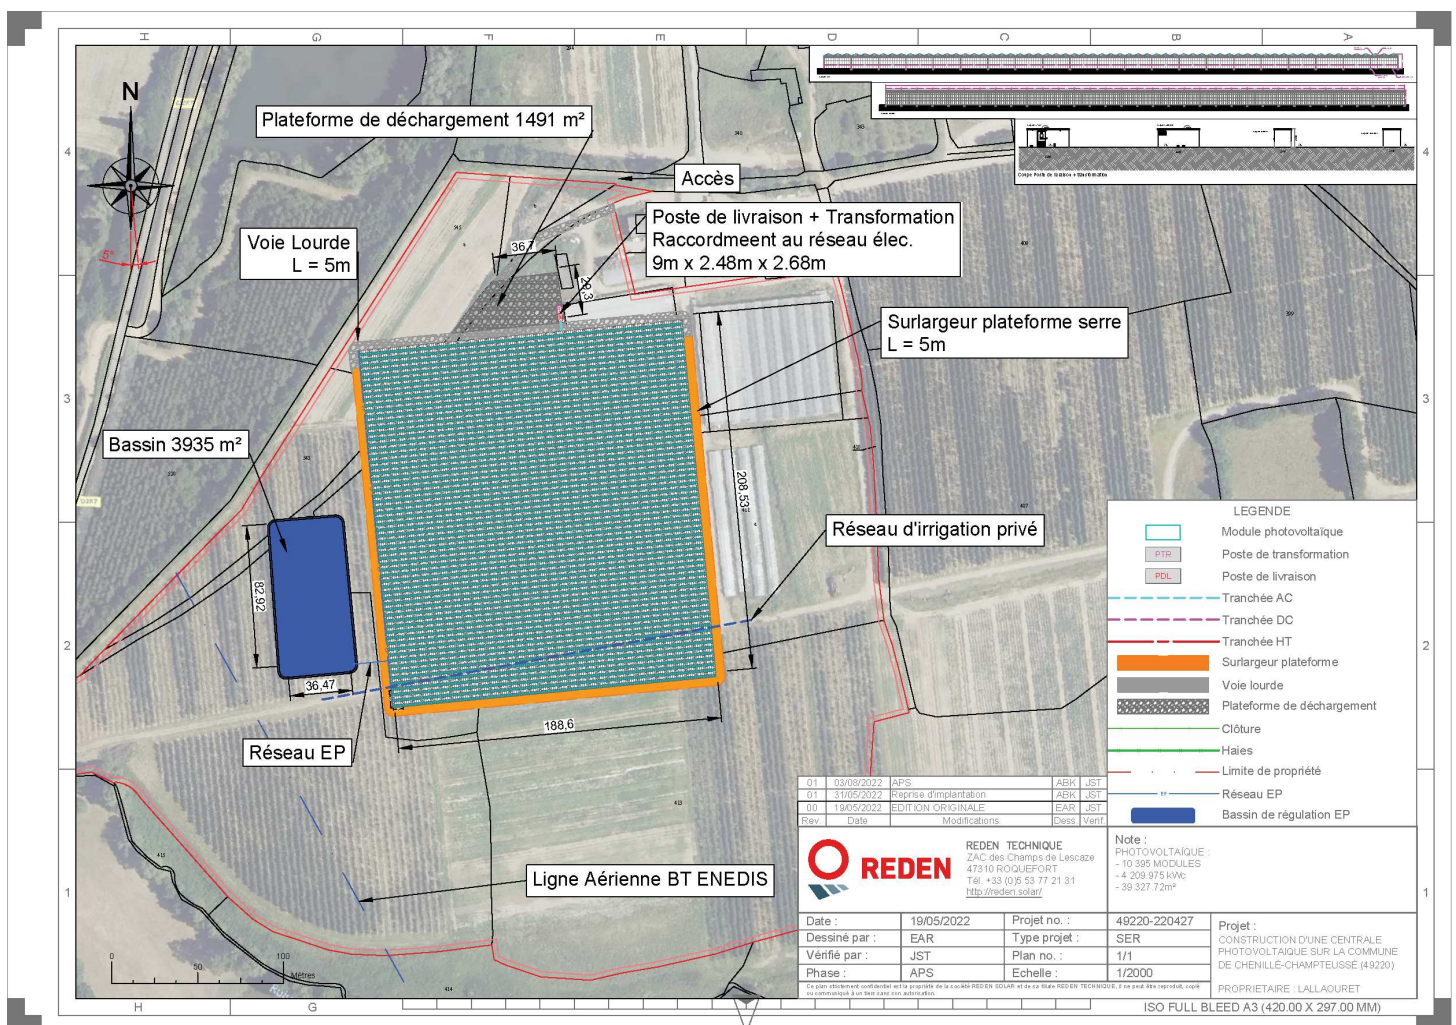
Implantation du projet : plan de la serre. Source : REDEN, 2022.
